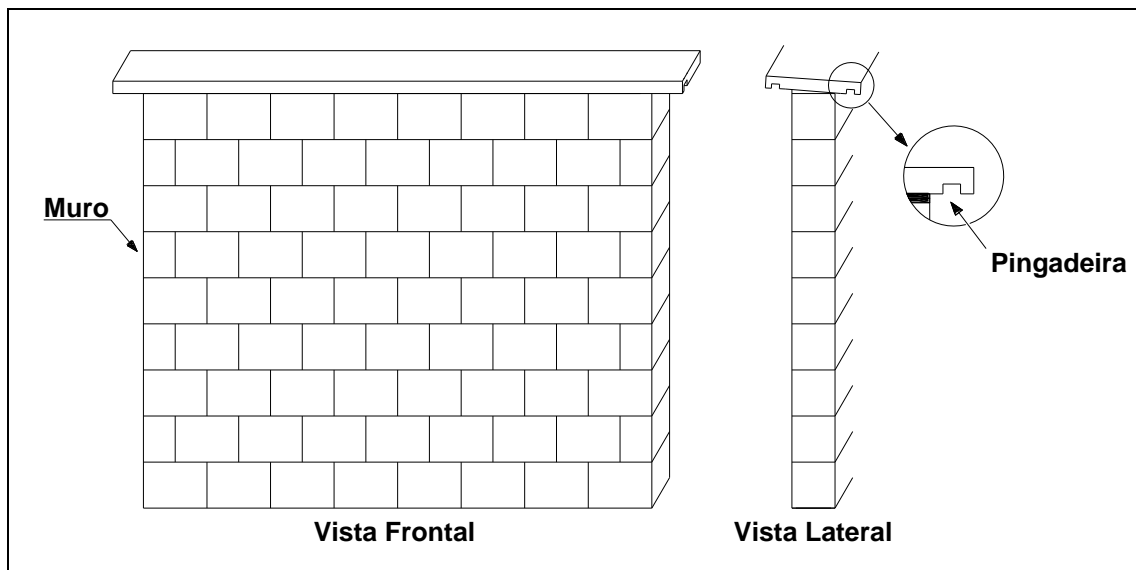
Detalhe construtivo dos muros: assentamento de pedra com pingadeira
